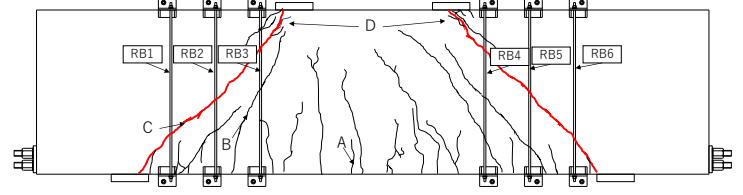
最大荷重時のひび割れ状況（No.1）
